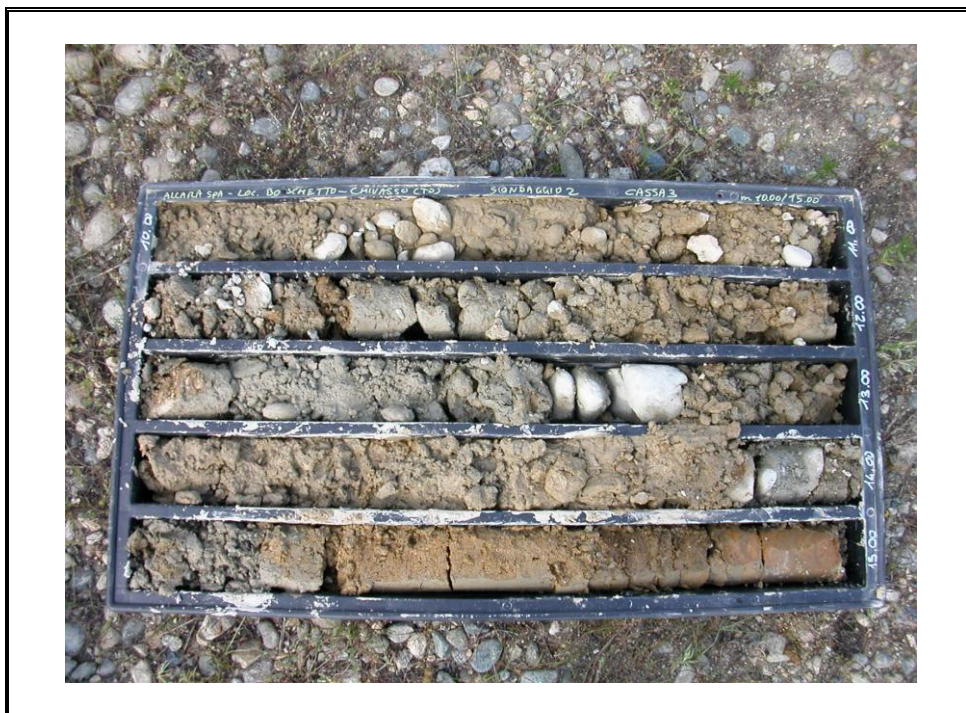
Sondaggio S2 - cassa 3 - da 10.00 m a 15.00 m.
